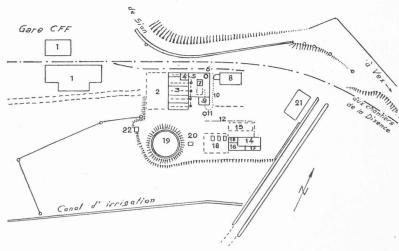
Plan de situation. — Echelle 1: 2500.
